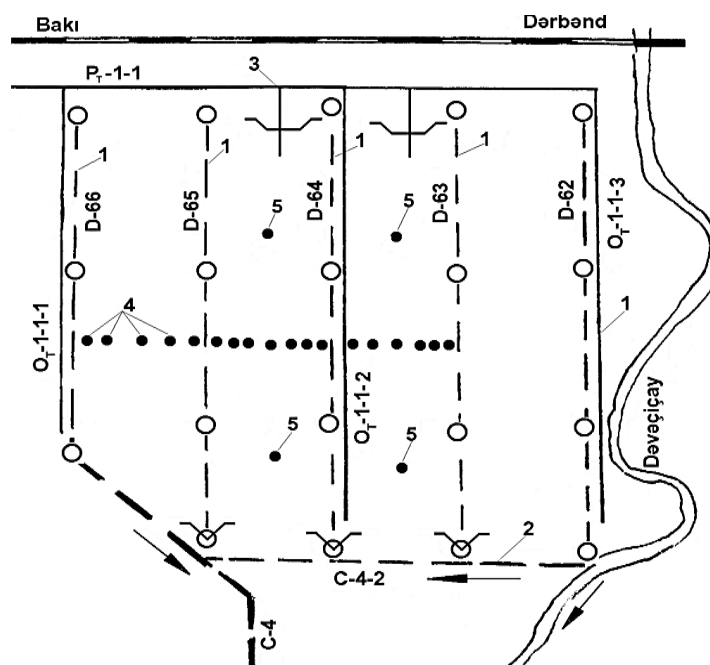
Опытно-дренажный участок с закрытыми дренажами с керамическими трубами с отверстиями покрытой водоливом с. Гюлемли Шабранского района
